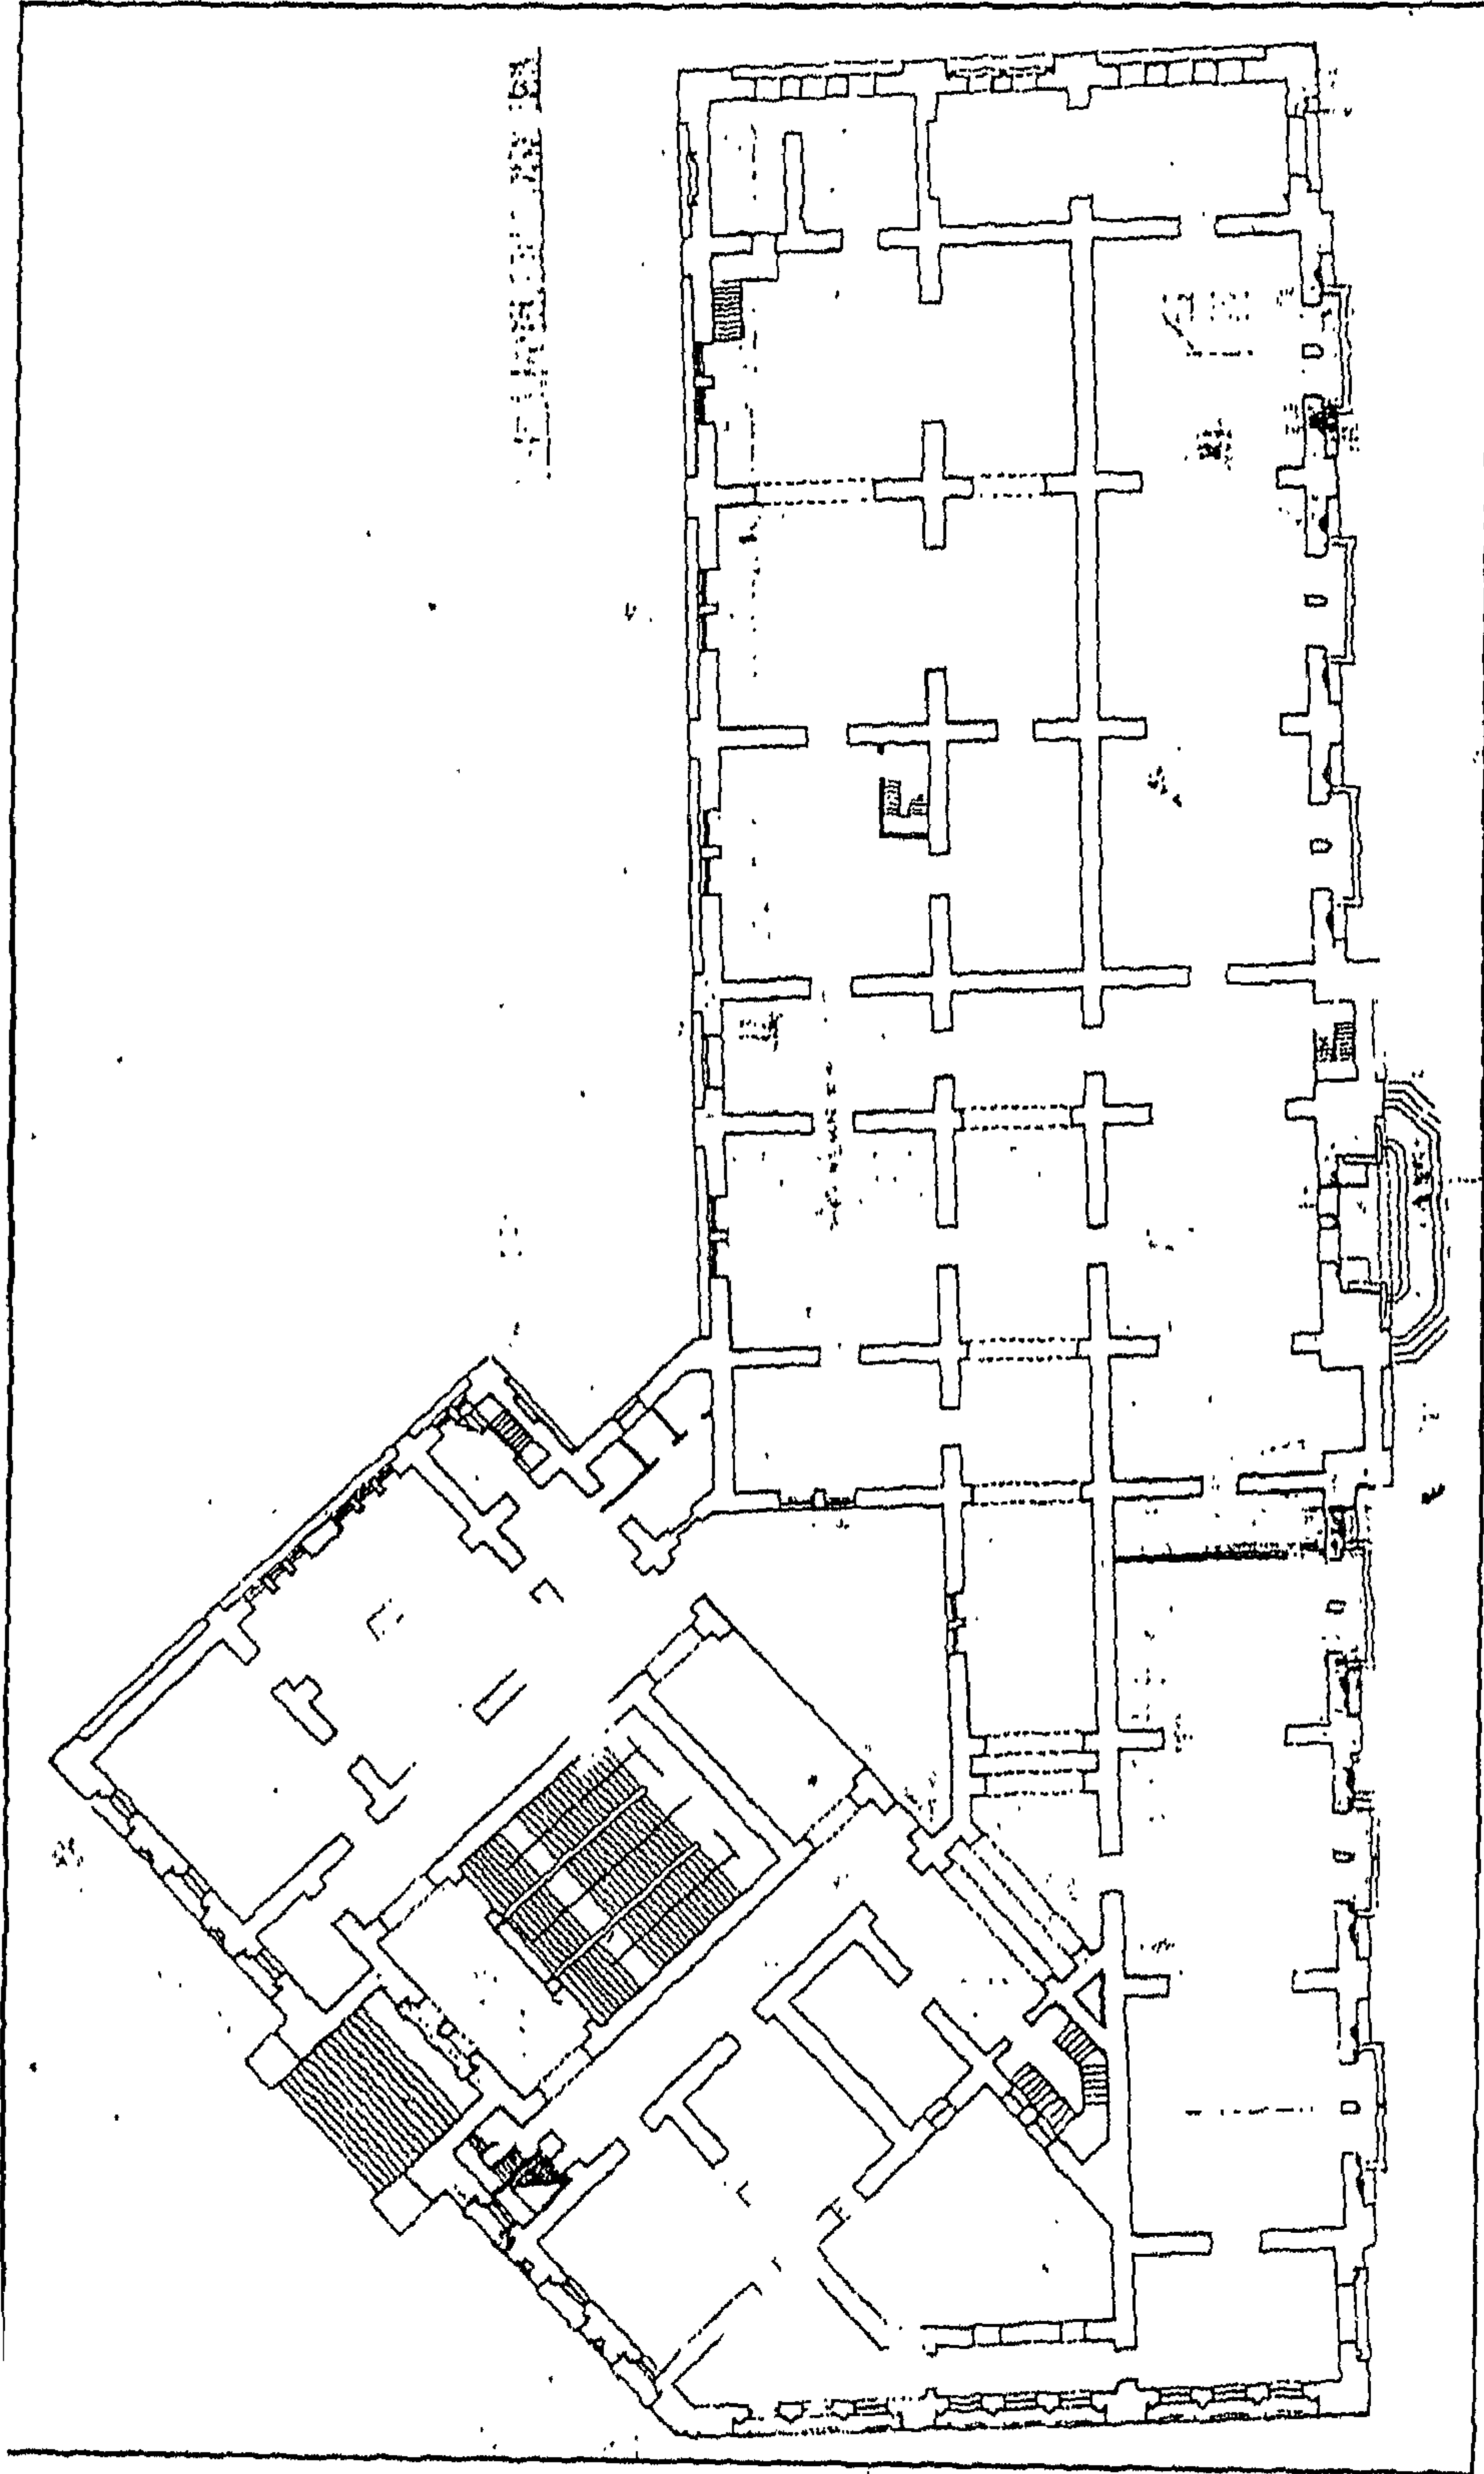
مبنى المتحف المصري - مسقط أفقي للطابق الأرضي (عند دليل المتحف)
